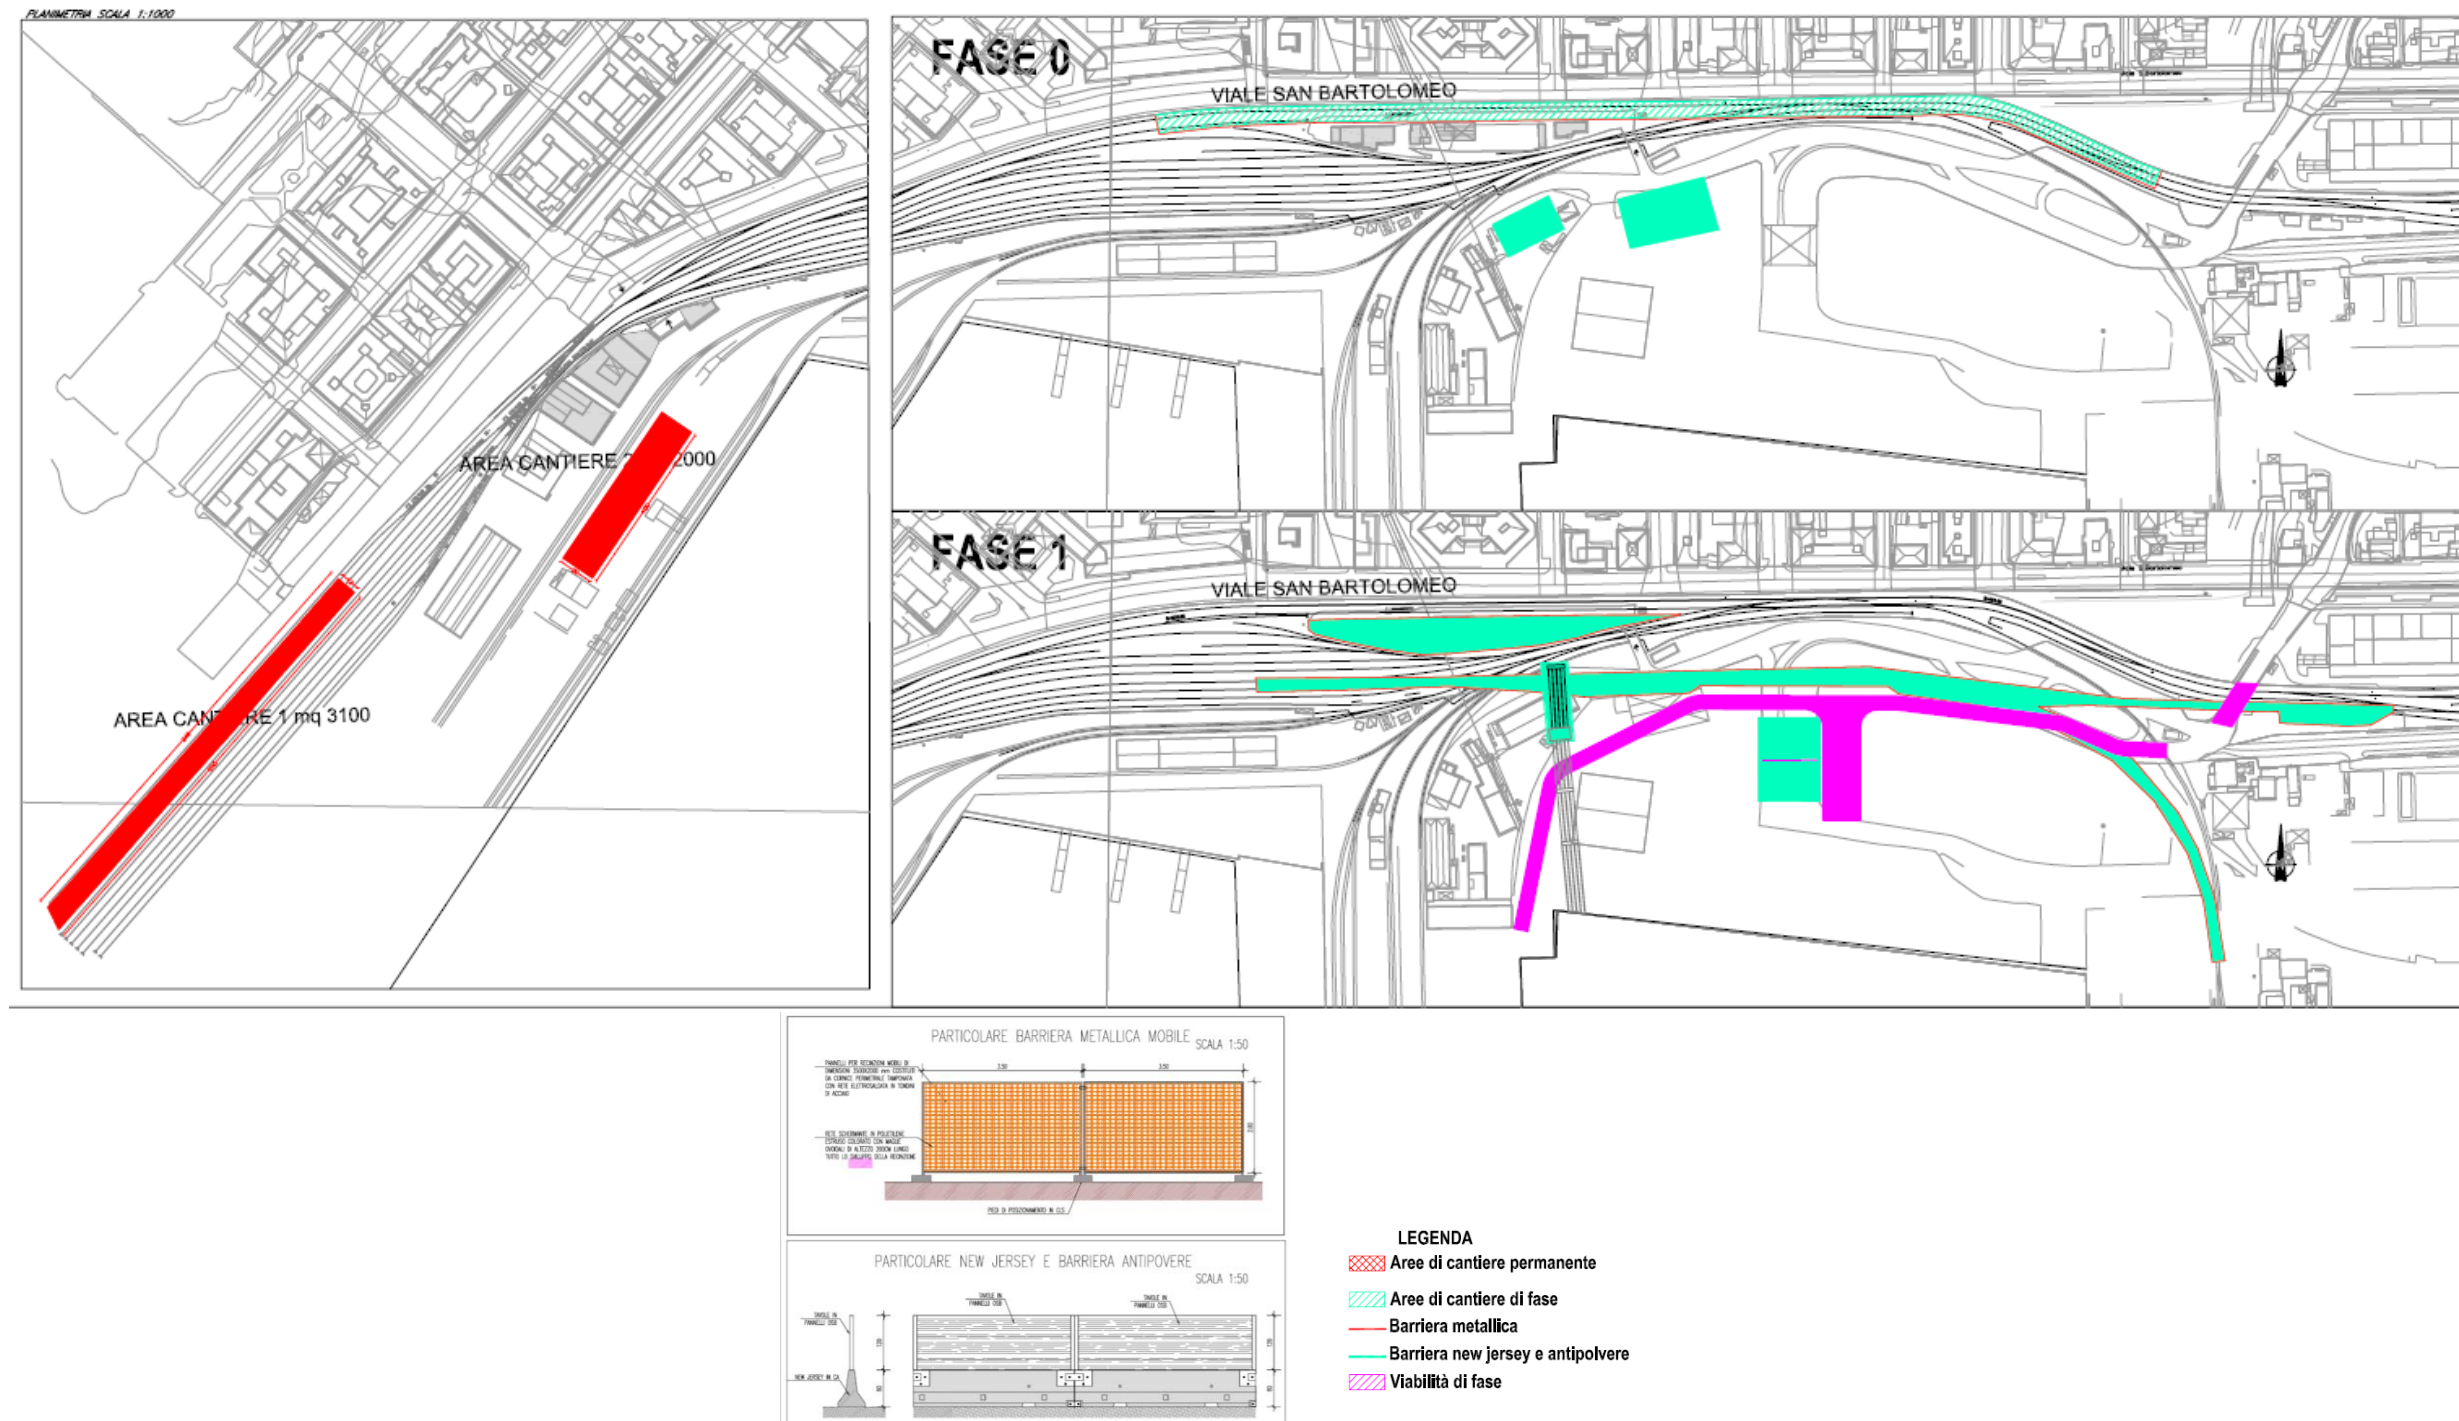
Planimetria con indicazione delle fasi realizzative – Fasi 0 e 1
